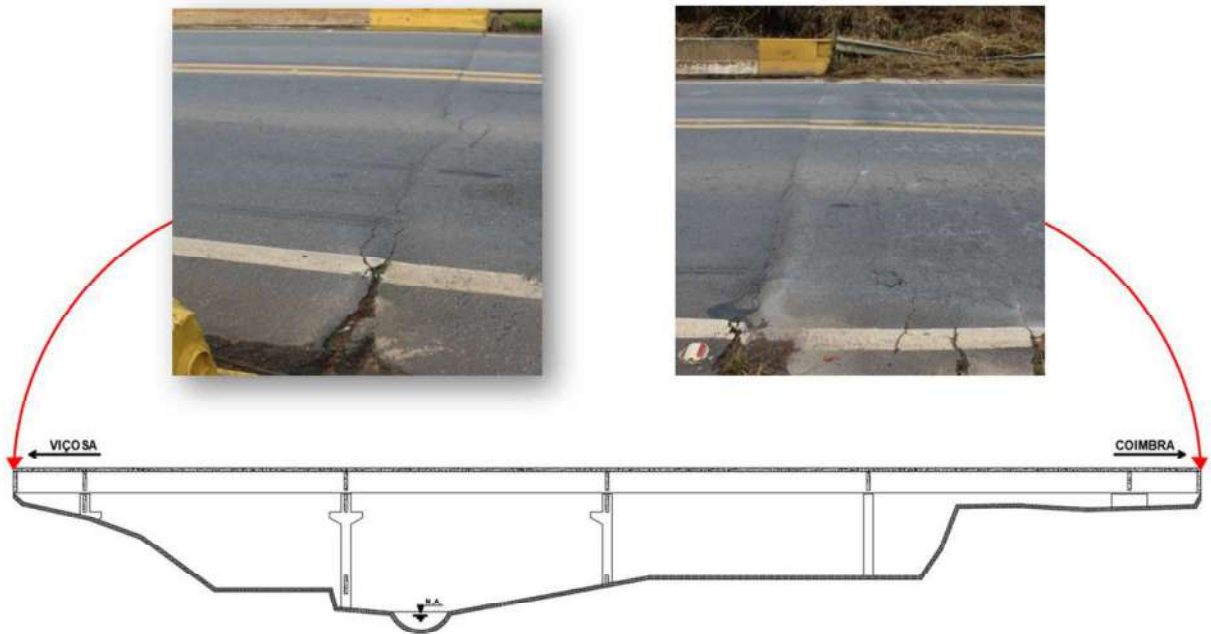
Fissuras na laje do tabuleiro – Parte 2.
